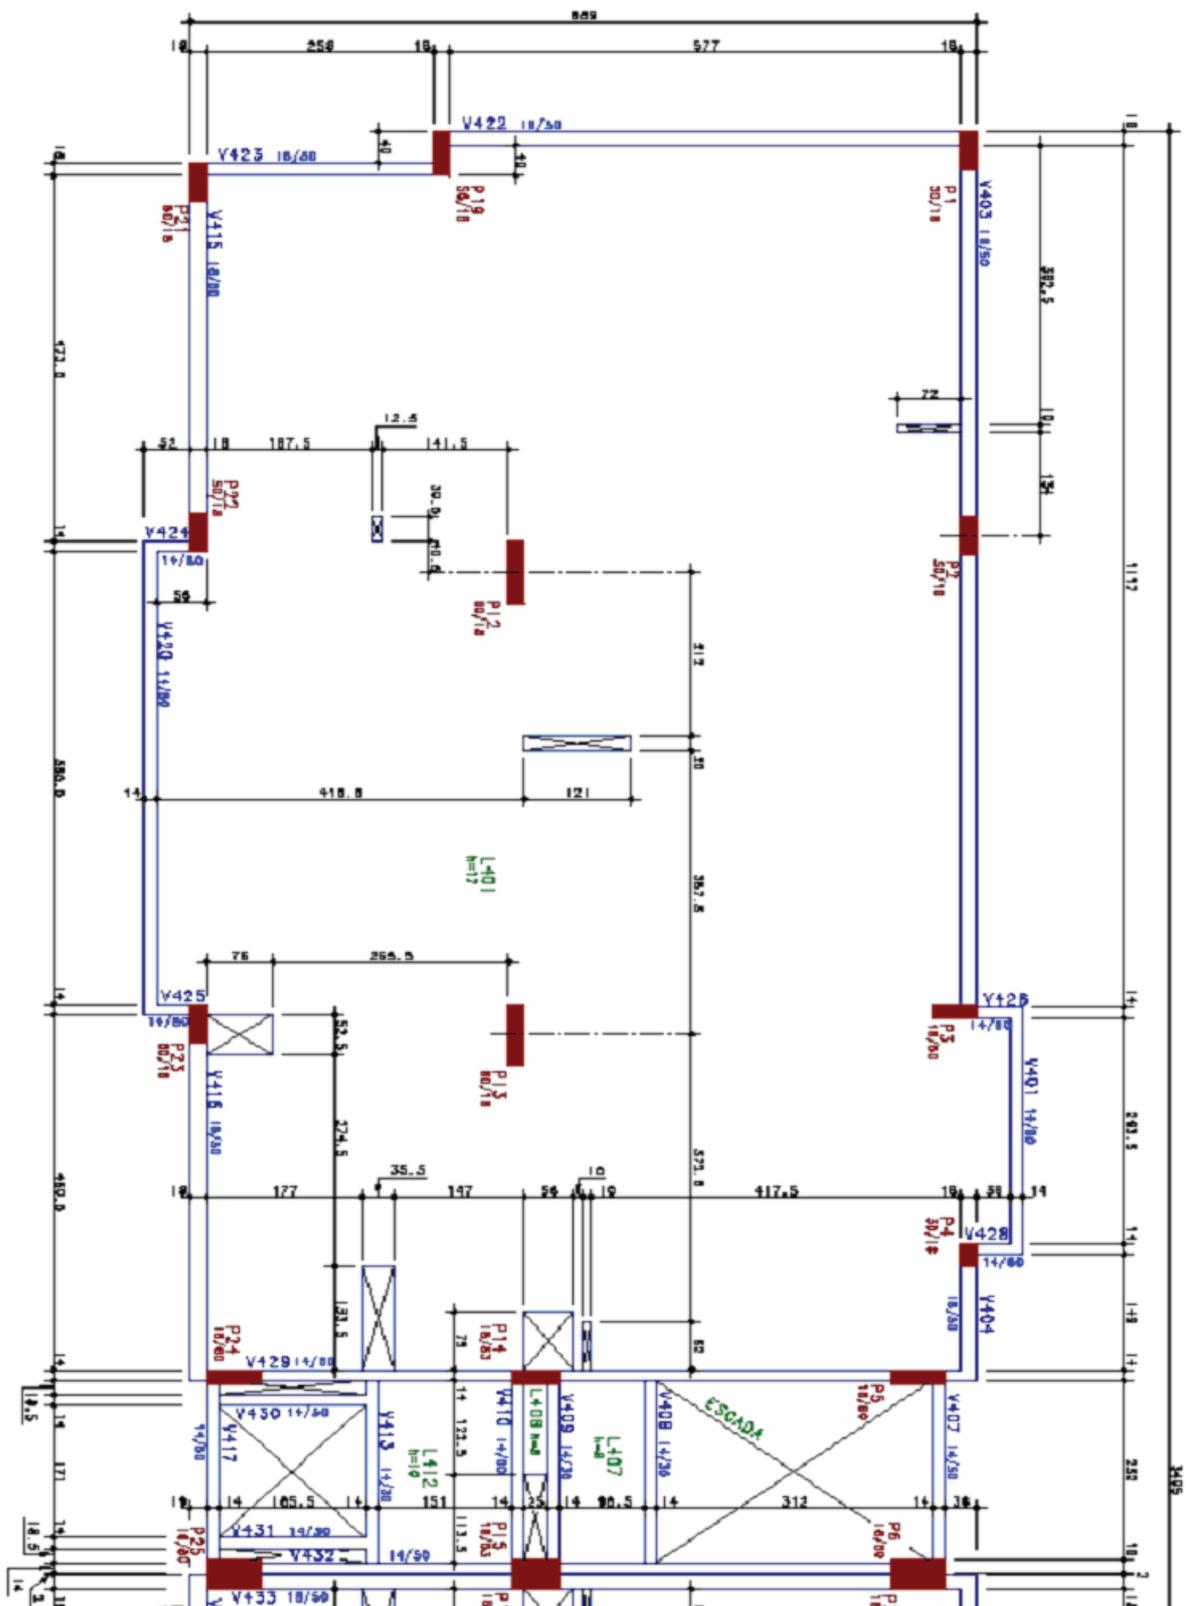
planta de fôrmas reduzida do pavimento tipo em laje lisa<sup>23</sup>
